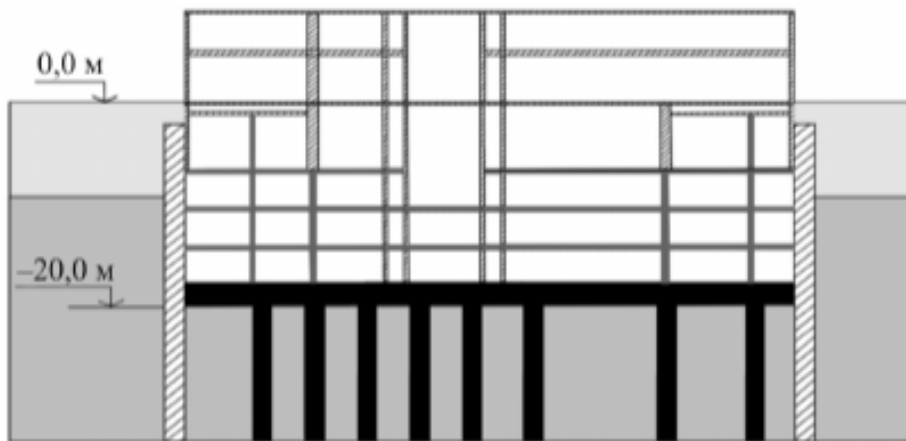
Порядок производства работ по методу «сверху-вниз» на 4-м этапе: бетонирование фундаментной плиты; завершение этажа –5; возведение этажей 1–4; остановка водопонижения; продолжение монолитных работ до n-го этажа
